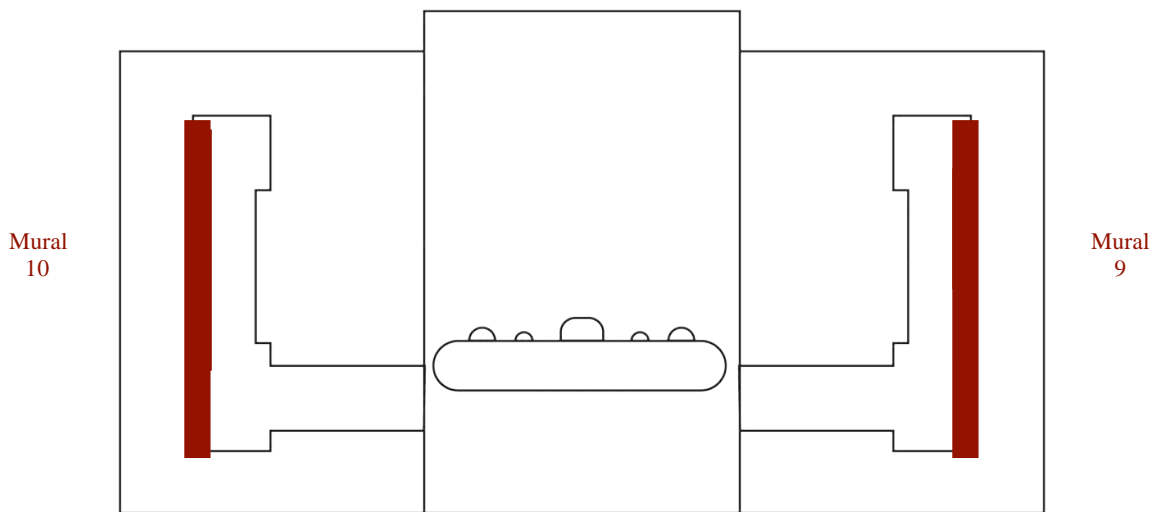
Murales 9: Disco solar este y Mural 10: Disco solar oeste. Planta del adoratorio.
